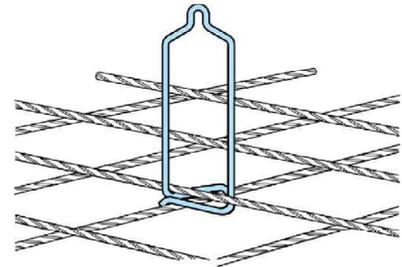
Unter gleichzeitigem Zusammendrücken der Schenkel mit Rechtsdrehung auf unteren Bewehrungsstab einschnappen lassen.
